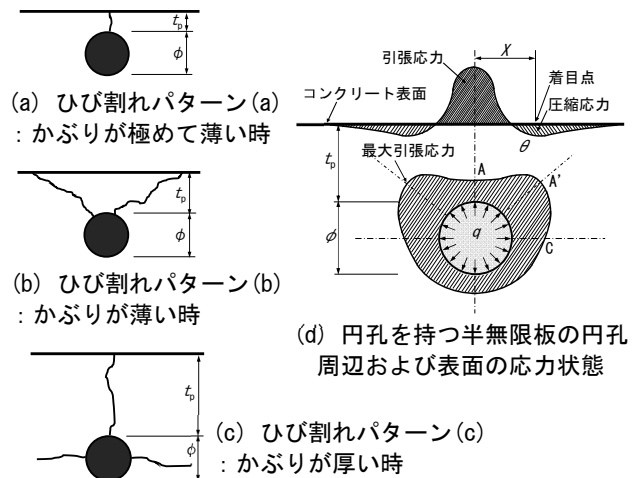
ひび割れパターンと応力状態(模式図) ³⁾を参考に作成
